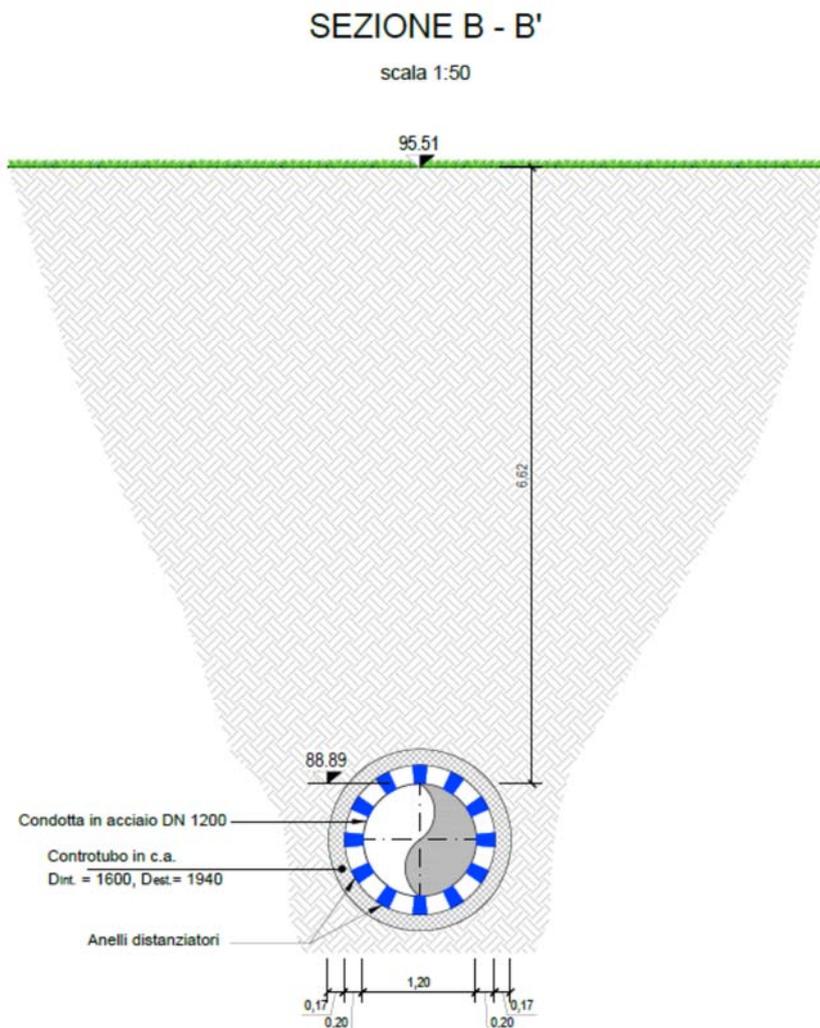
Sezione tipologica di attraversamento di Lama Lioy e Lama Cupa.
